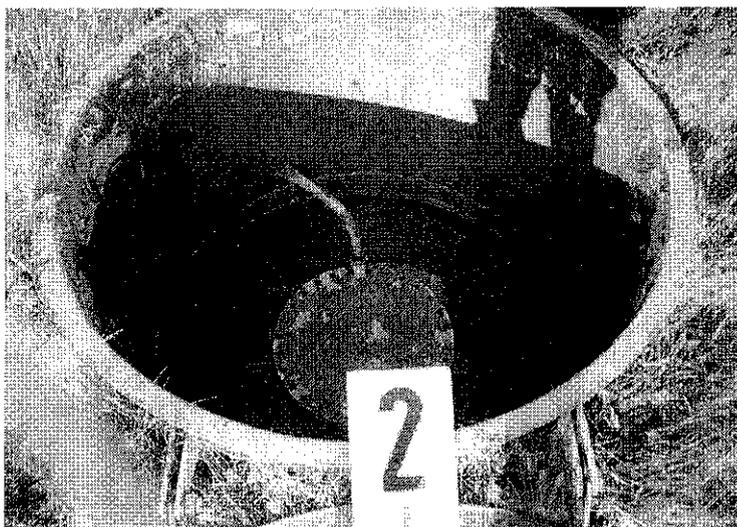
Domschacht Tankmitte Erdtank 2 (VK); Tankdeckel verschlossen; in Domschacht steht Wasser; Aufnahme vom 13.11.01
